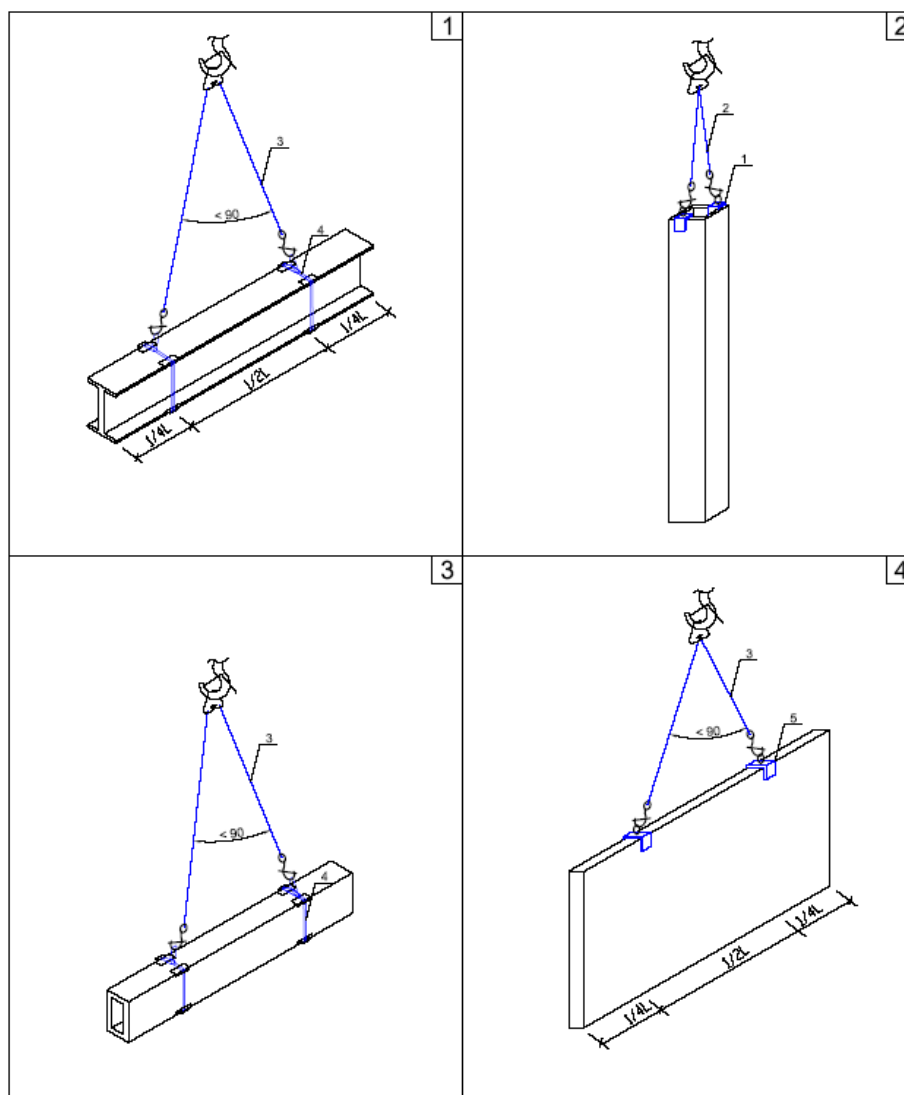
Схемы строповки и перечень грузозахватных приспособлений
